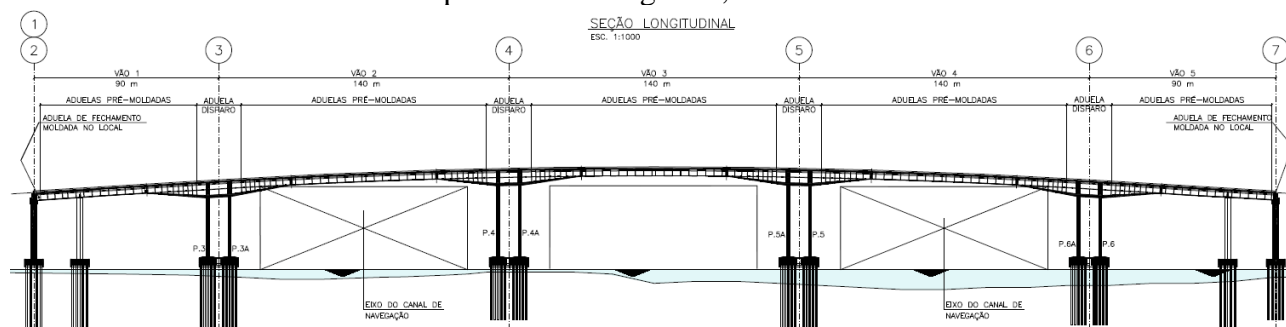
Elevação longitudinal da Nova Ponte do Guaíba.
